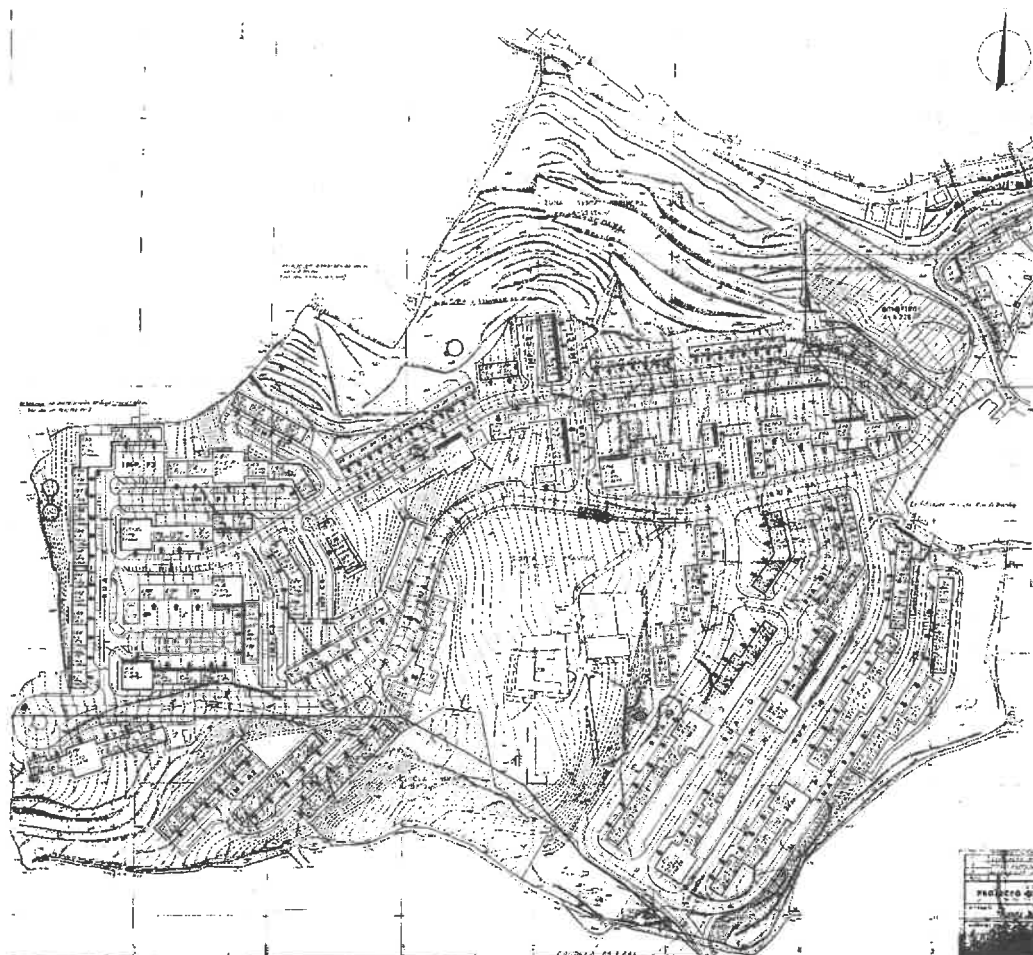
Planta de Implantação do Loteamento da Quinta do Brandão
